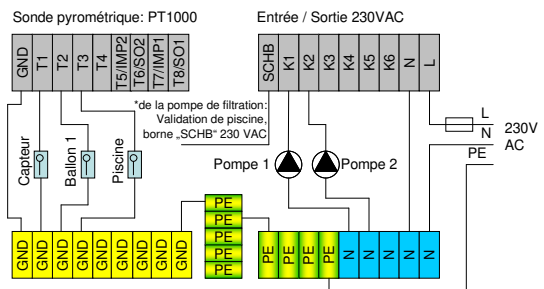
Schéma (3.3) 1F1S1WSP, plan de connexion
